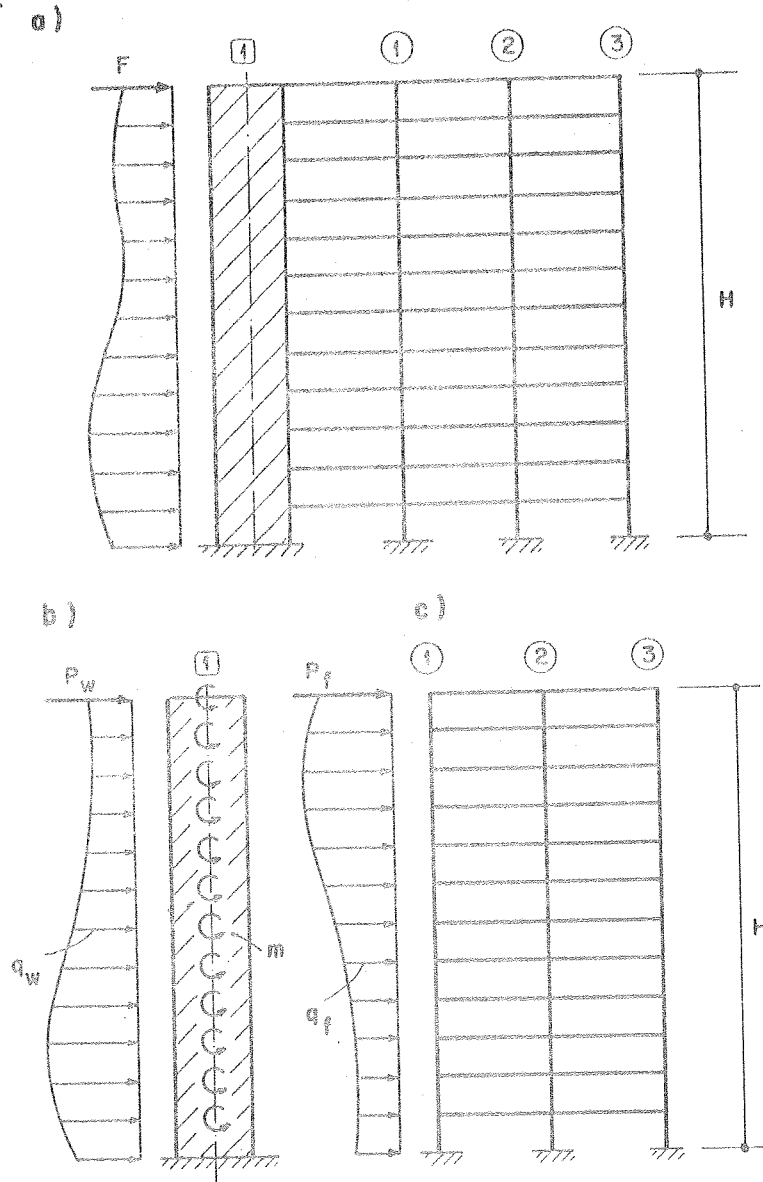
PÓRTICO E PAREDE LIGADOS POR LINTEIS
